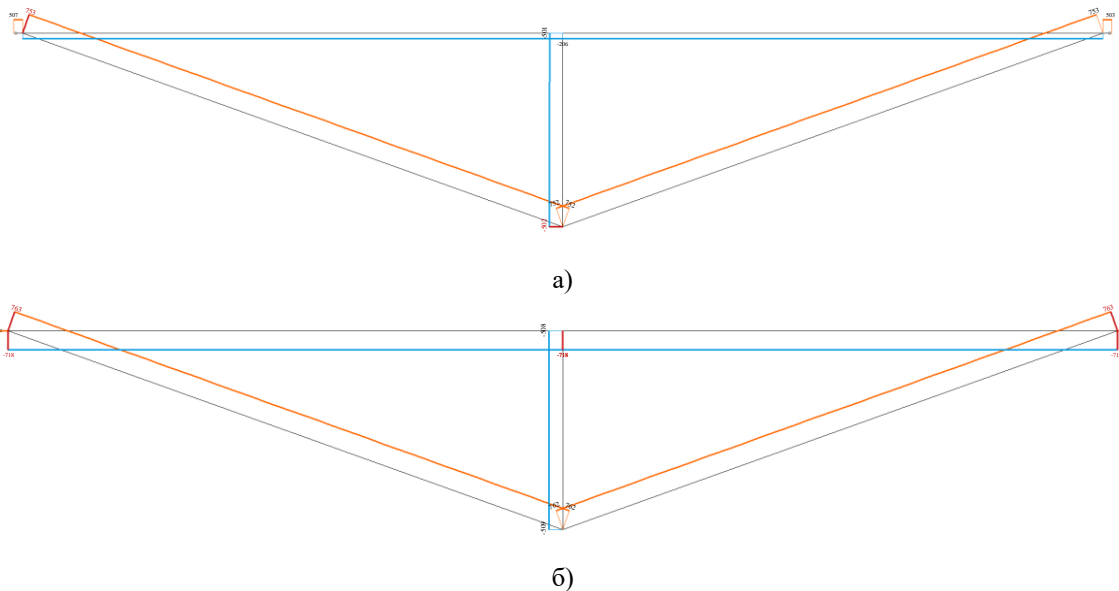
Эпюры продольных сил в элементах подстропильной фермы:
